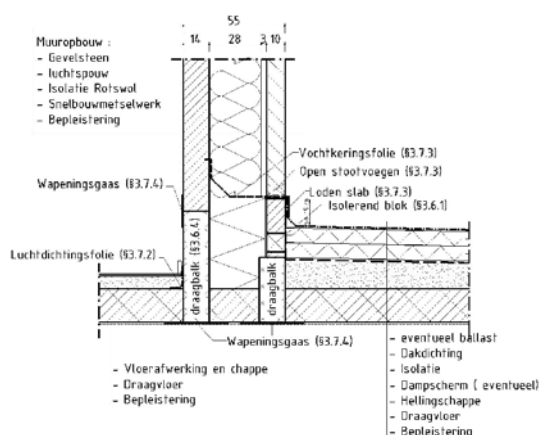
Aansluiting plat dak-opgaande muur met cellenbeton
